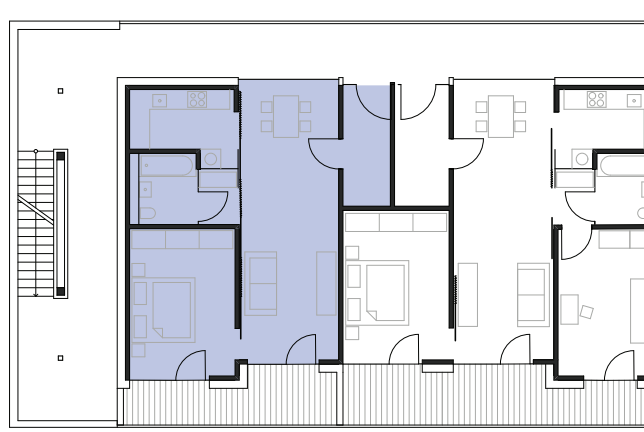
Grundrissausschnitt des Wohngebäude europan BA4 Permoserstraße mit der Erschließung über Laubengänge
